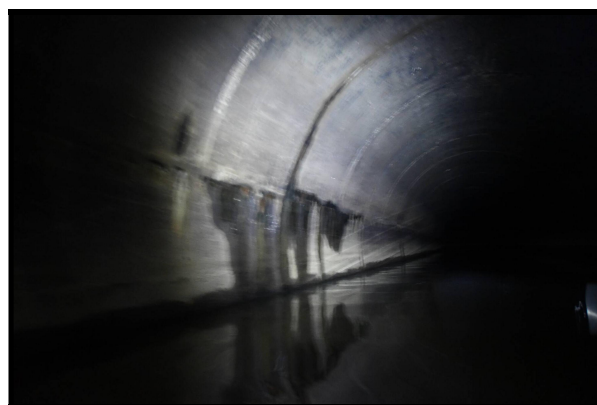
Infiltração em junta horizontal de construção próximo a boca de saída.
